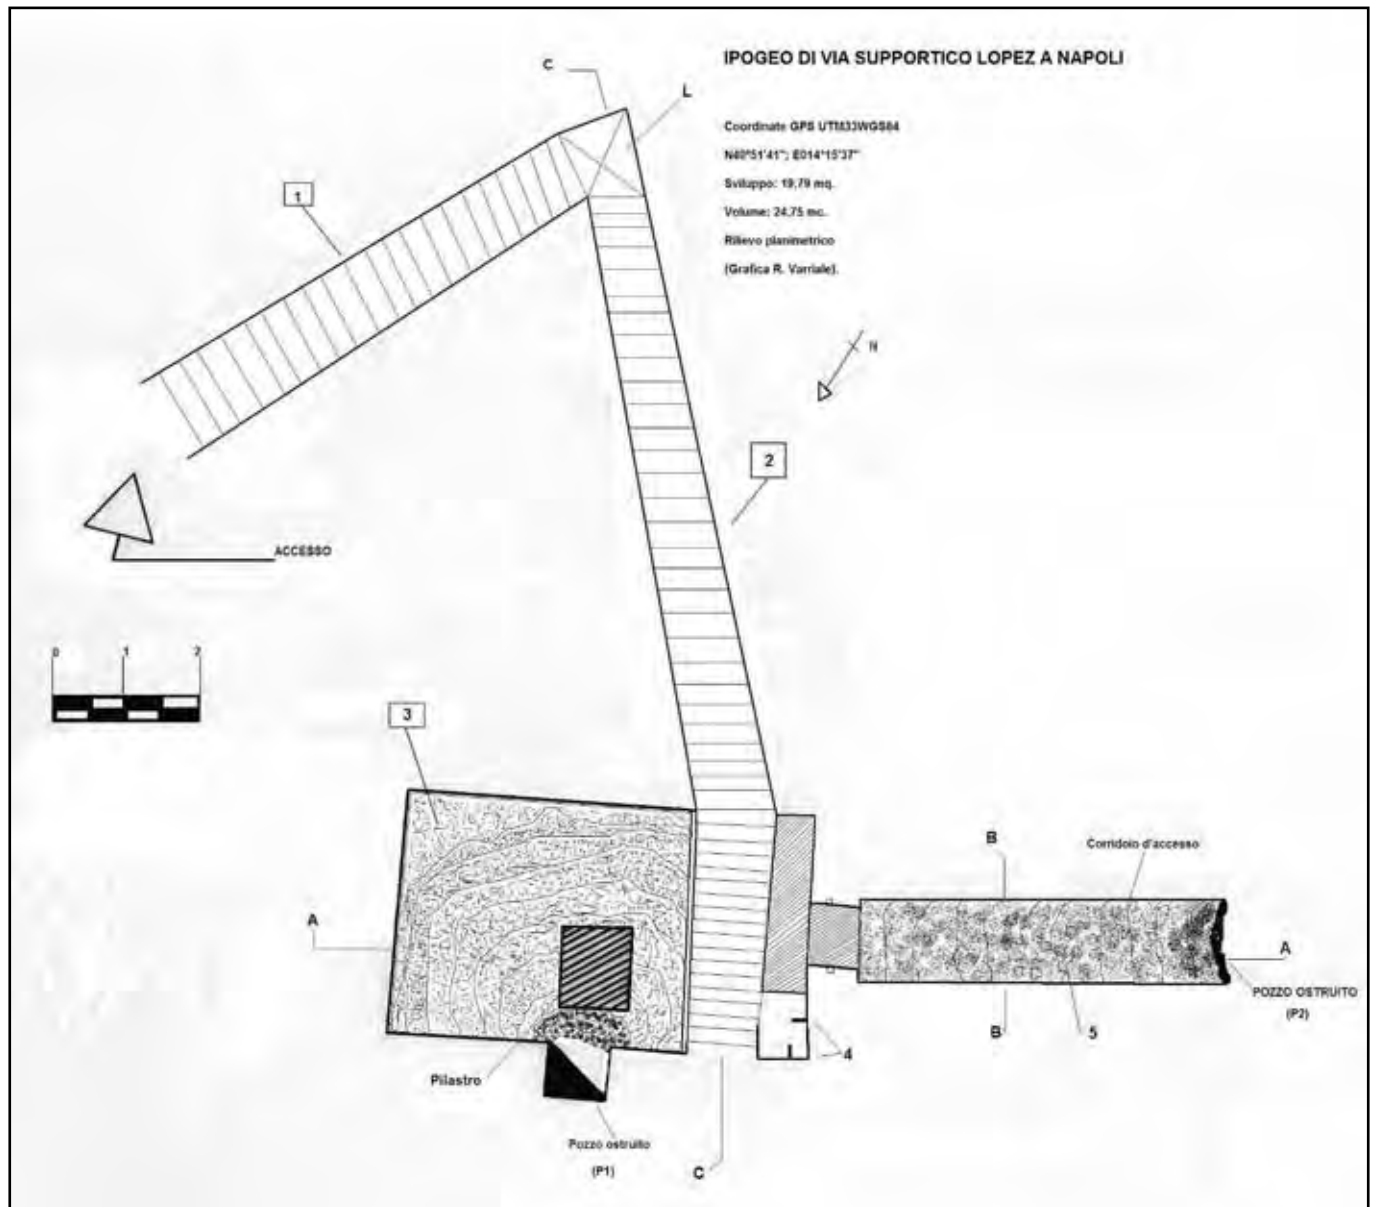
Planimetria dell'ipogeo (grafica R. Varriale).
